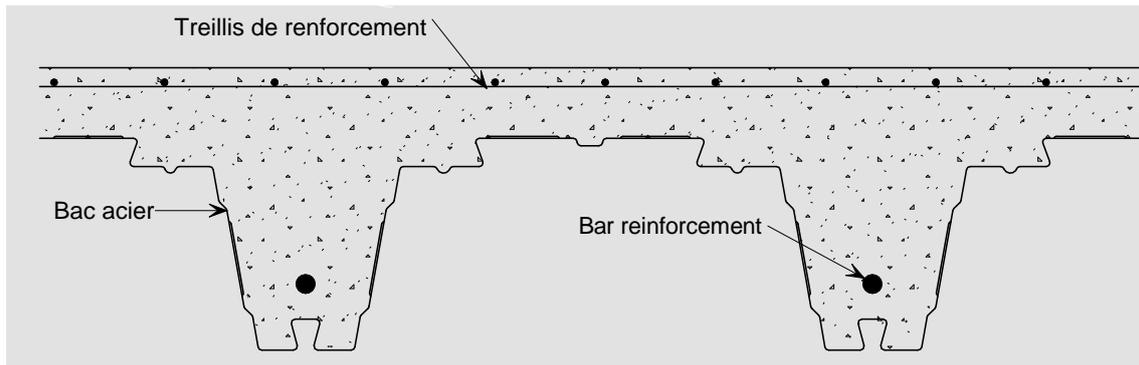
Dalle mixte avec bac acier de forte épaisseur
